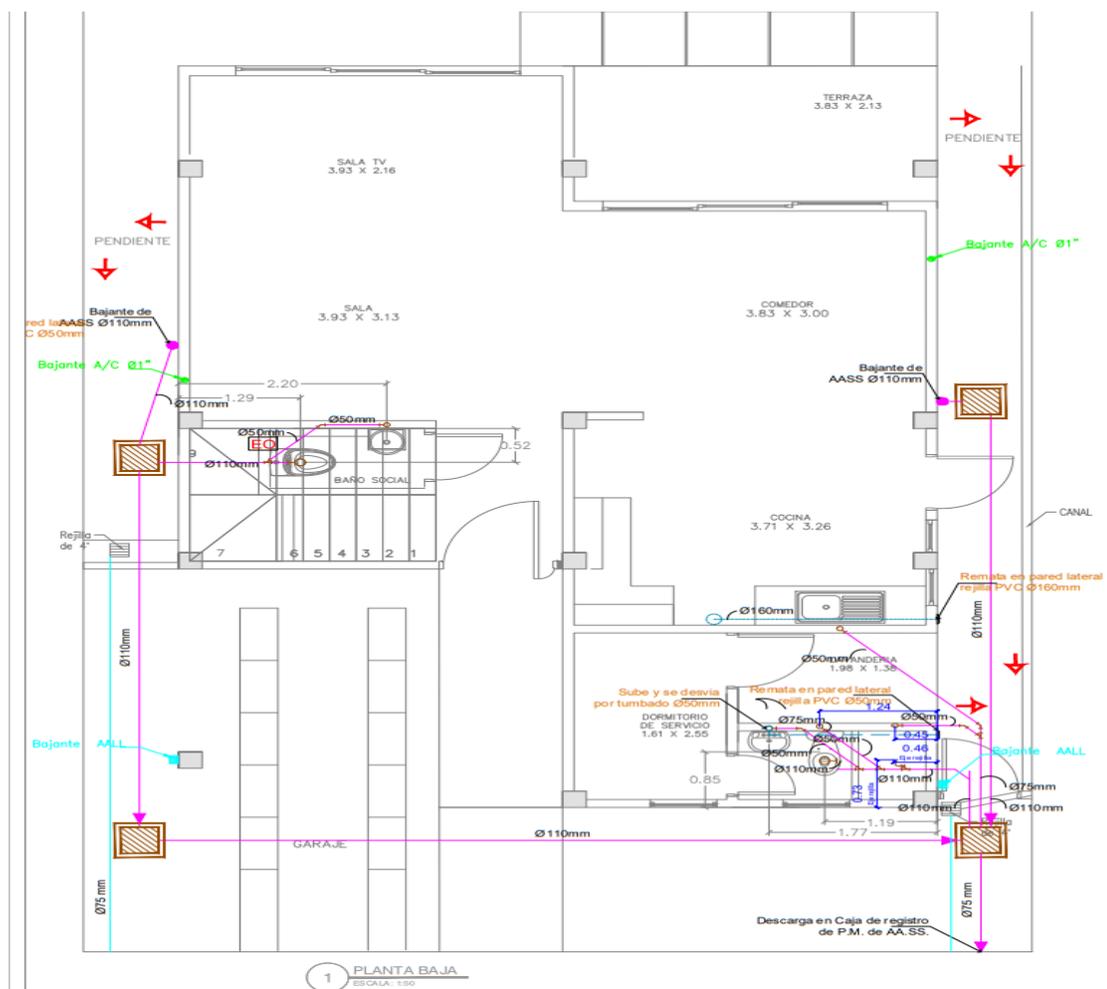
Diagrama de AA.SS de planta baja en AutoCAD. (Inmovila 2023)
